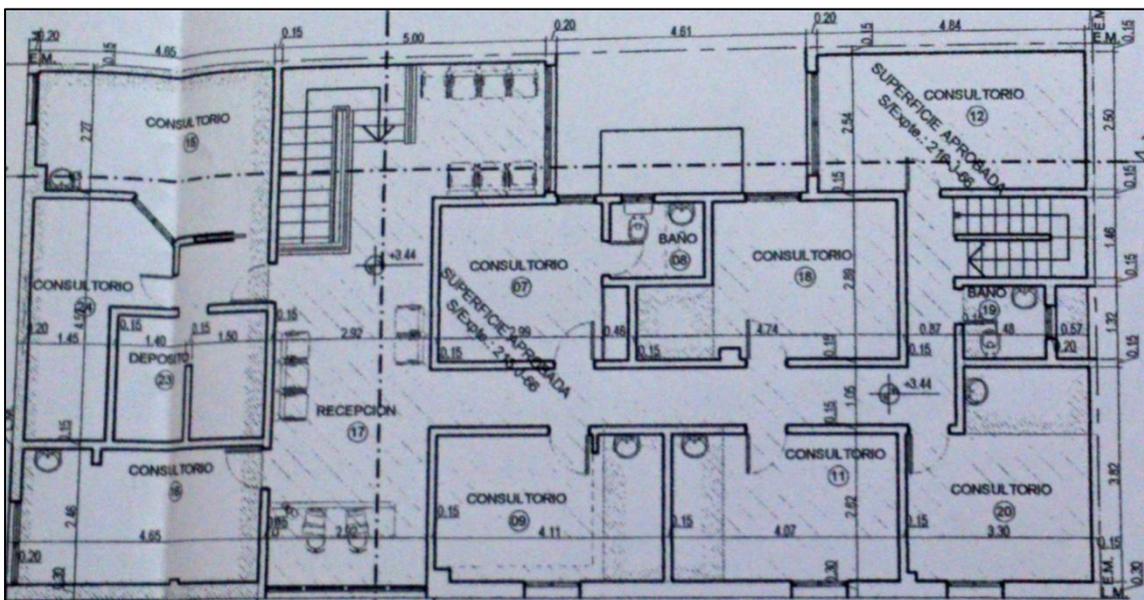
LAY OUT ACTUAL CE, PRIMER PISO.
